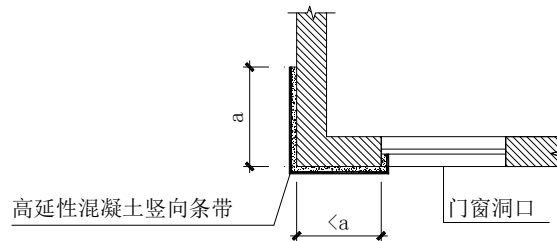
外墙阳角距洞口边距离小于 a 时竖向条带布置示意图
